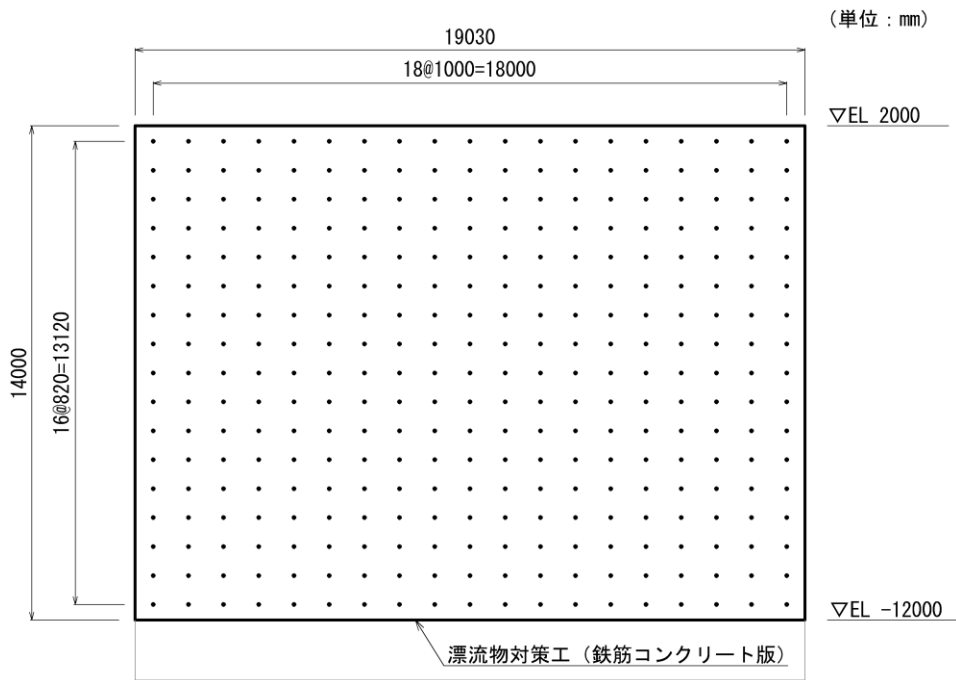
(3) 防波壁 (波返重力擁壁) ケーソンにおける漂流物対策工 (鉄筋コンクリート版) のアンカーボルト配置図 (正面図)
